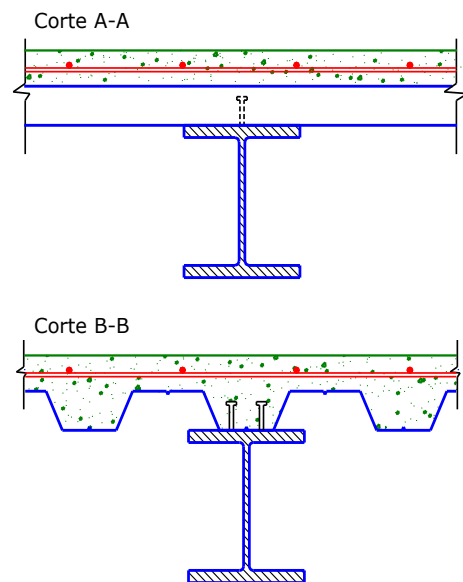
Secciones de viga compuesta, Corte A-A: nervios perpendiculares a la viga, y Corte B-B: nervios paralelos a la viga.
